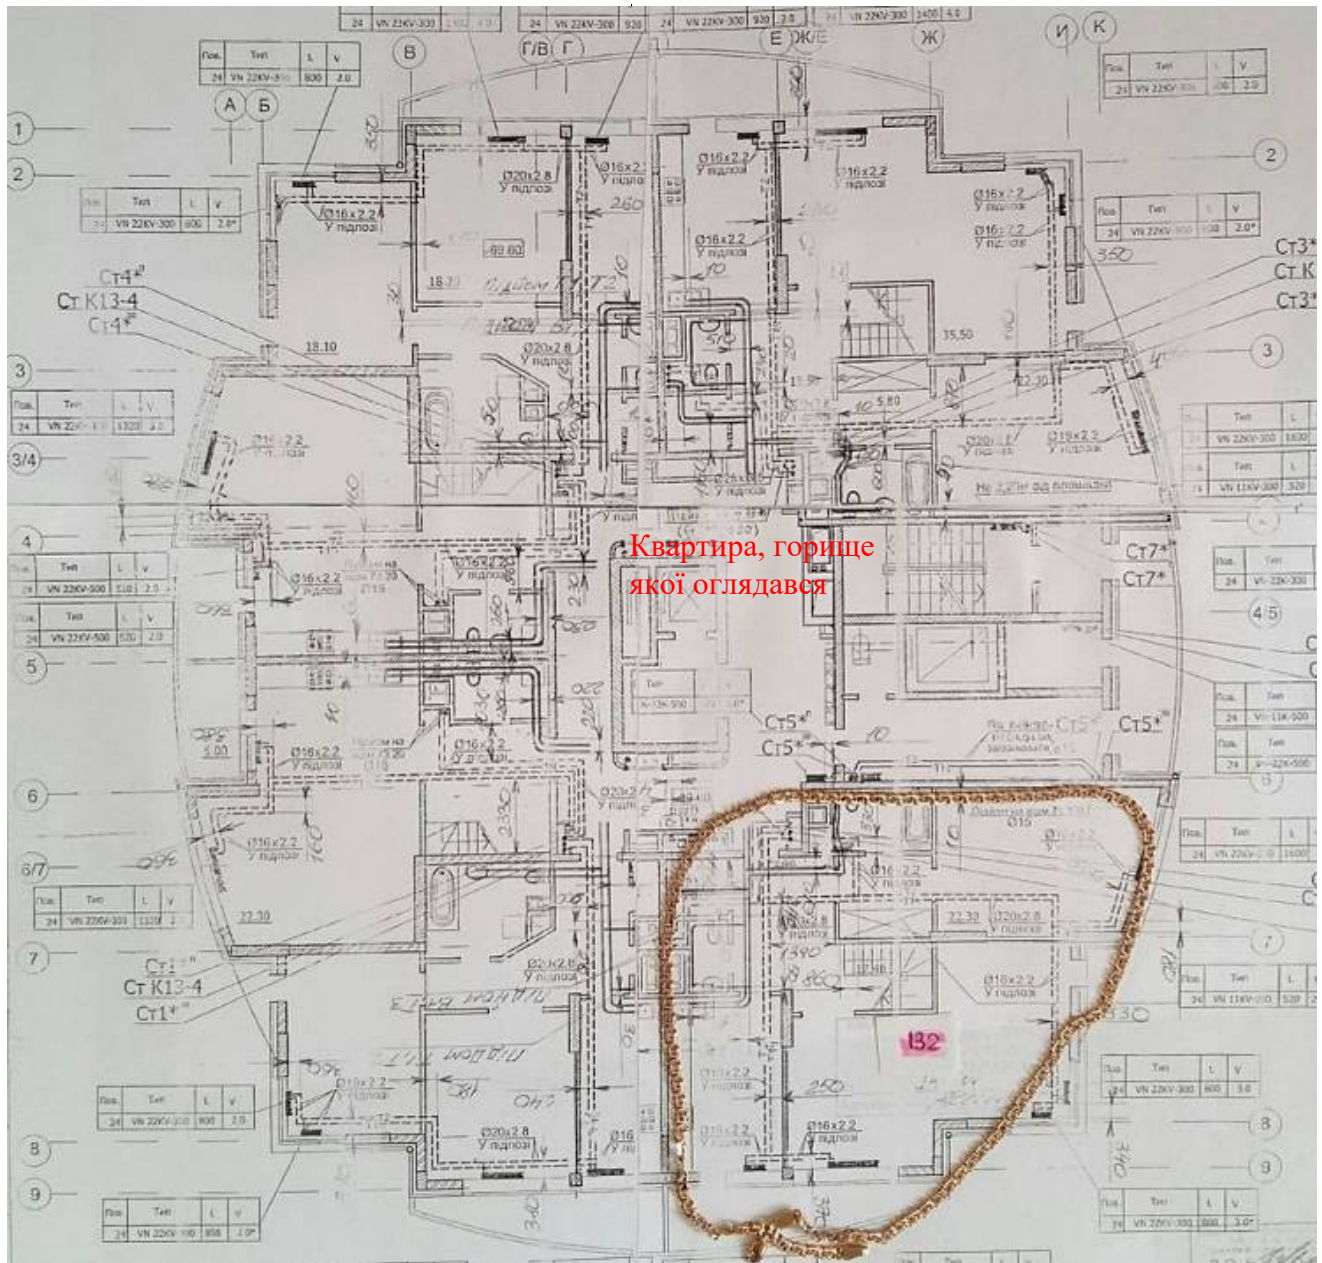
Схема розміщення фрагменту будівлі, що оглядалася, (24 поверх + горище в рівні 25 поверху) - початок.
